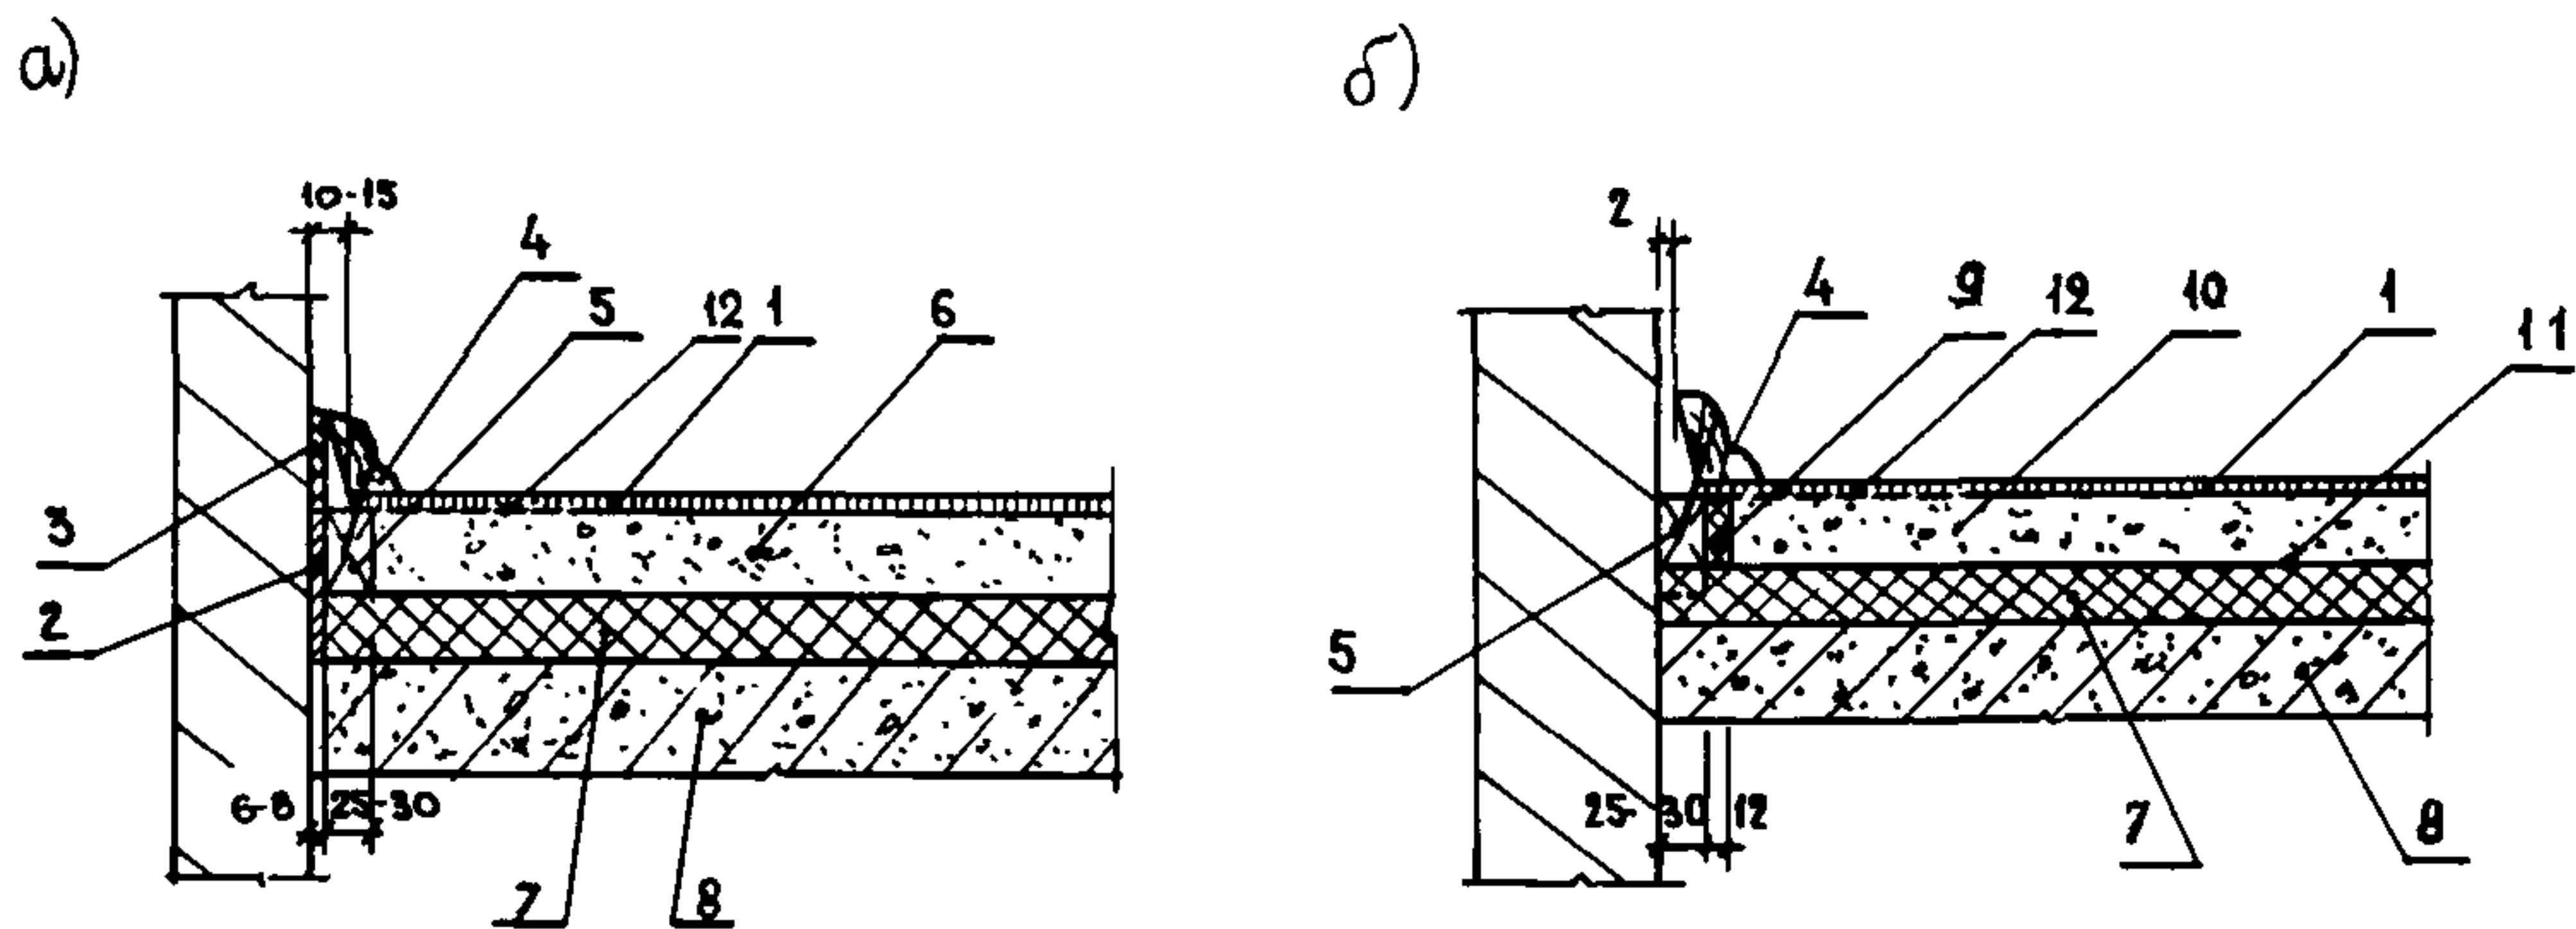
Узел примыкания полов к стенам и перегородкам (варианты полов с бетонными основаниями)
